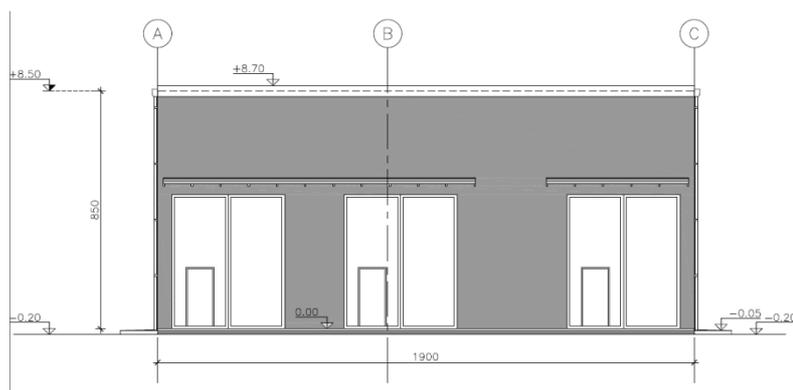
Prospetto Ovest *post operam* Deposito D2
